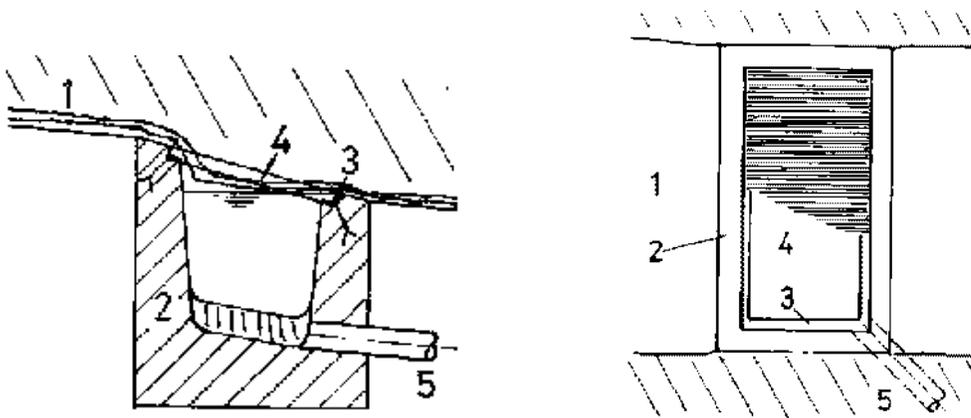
Obra de captación del arroyo 1. Lecho del río 2. Cámara de captación (de hormigón o de mampostería de piedra). El piso es inclinado hacia el tubo de salida. 3. Marco metálico anclado al borde de la cámara 4. Reja de planchuelas con cierre perimetral. La separación entre planchuelas es de 6 a 12 mm. La pendiente de la reja en la dirección del flujo es de 15° como mínimo. 5. Tubo de descarga a la cámara de carga y desarenador.
